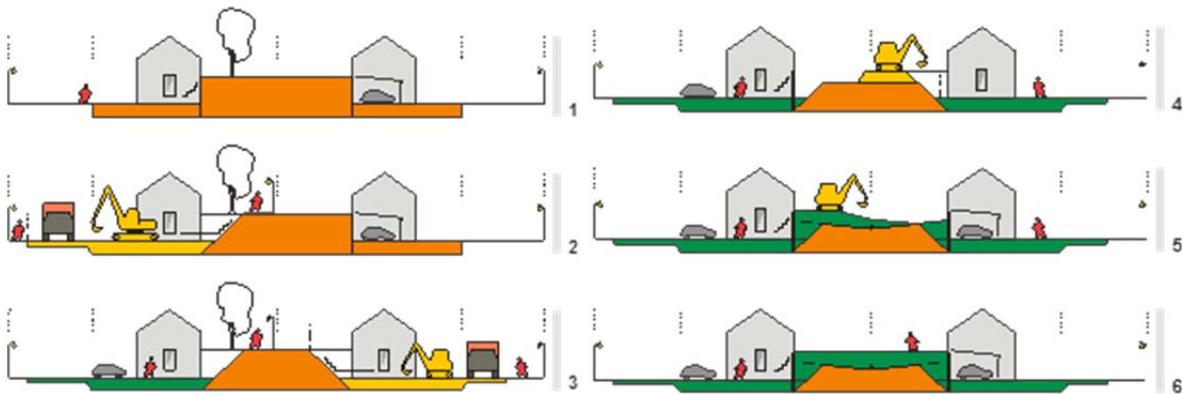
Schematischer Bauablauf „Wallsanierung“ – 3. Sanierungsabschnitt
